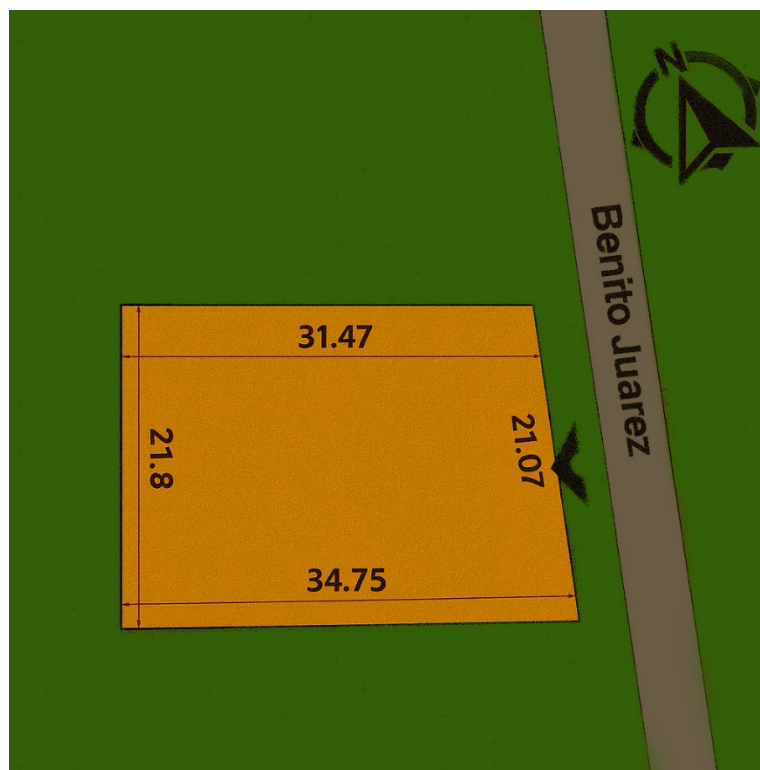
Planta de casa azotea en el predio de la casa #33. Hernández, 2018.
